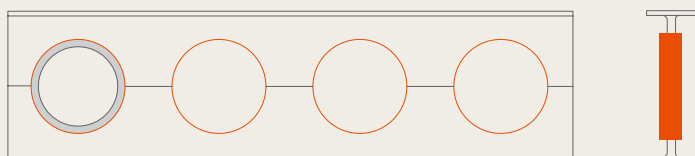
Exemple de poutre ACB® avec alvéole renforcée
